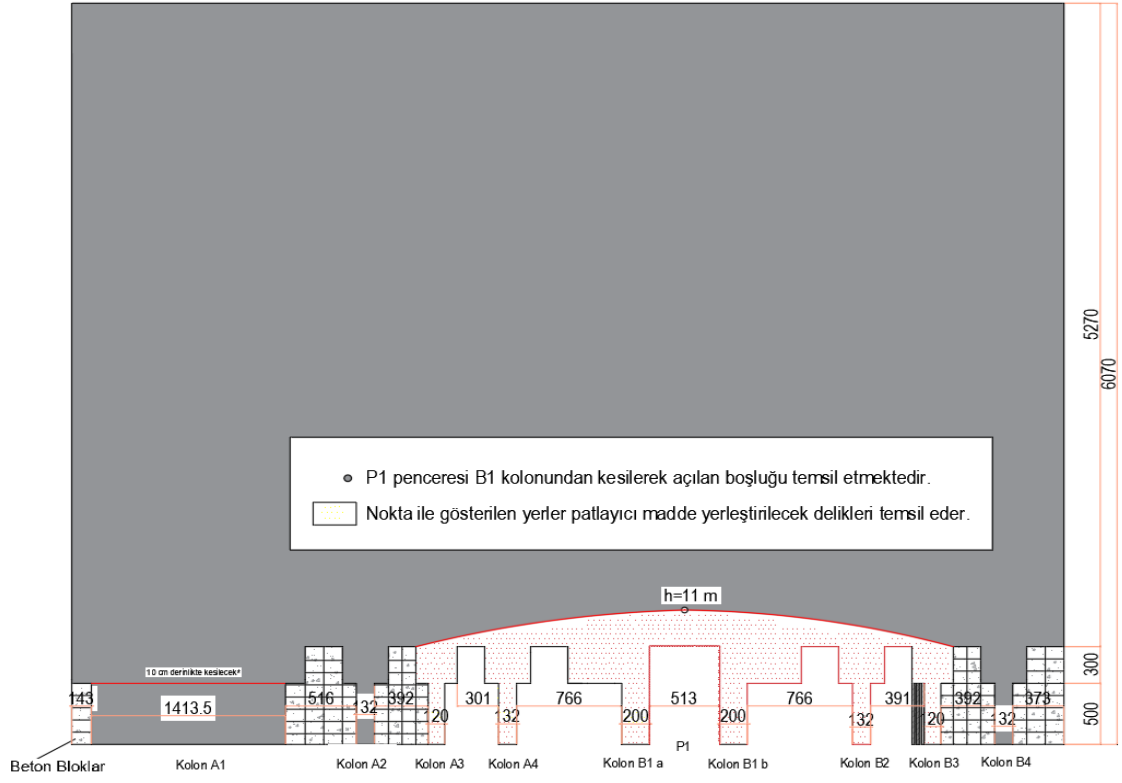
Kolon A3 – B3 boyutları ve donatı planı
